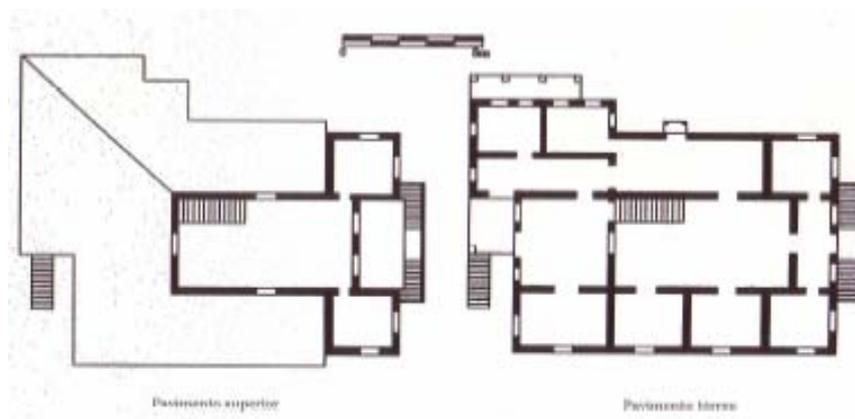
Plantas Baixas do Pavimento Térreo e do Pavimento Superior da Casa-Grande do Engenho Megaípe, em Muribeca - PE.
